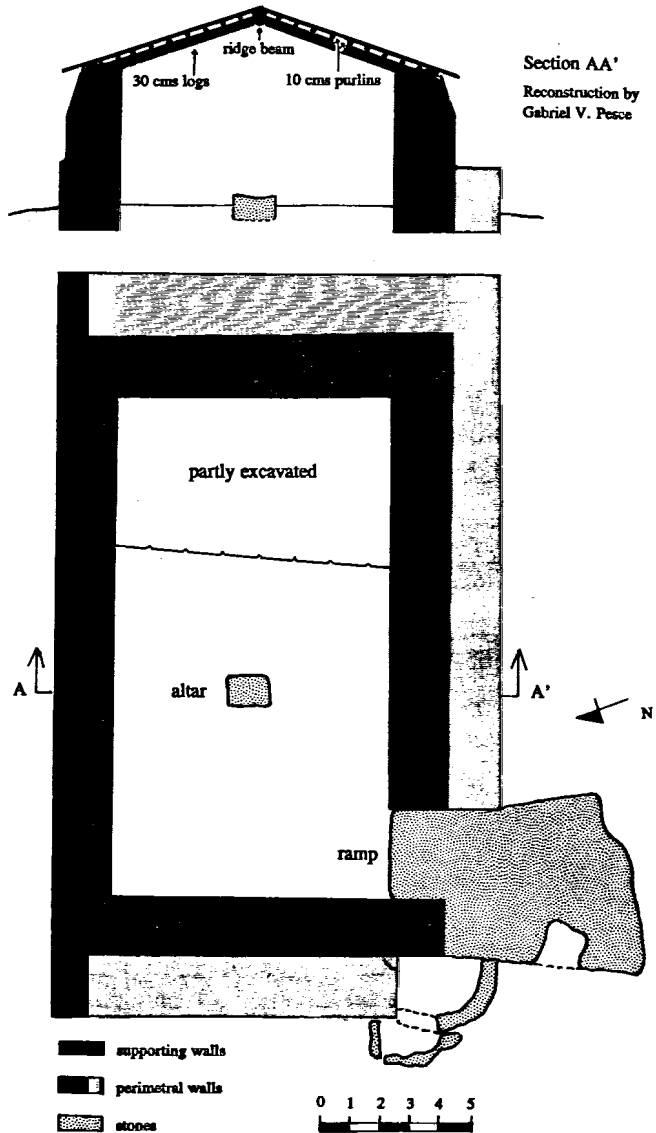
Planimetria del tempio BA, fase BI.A.
